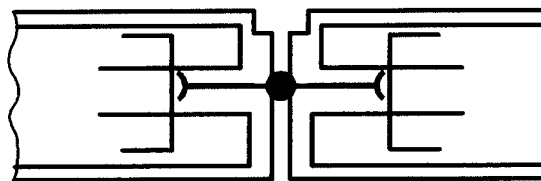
exemple de coupe sur bande d'arrêt d'eau
